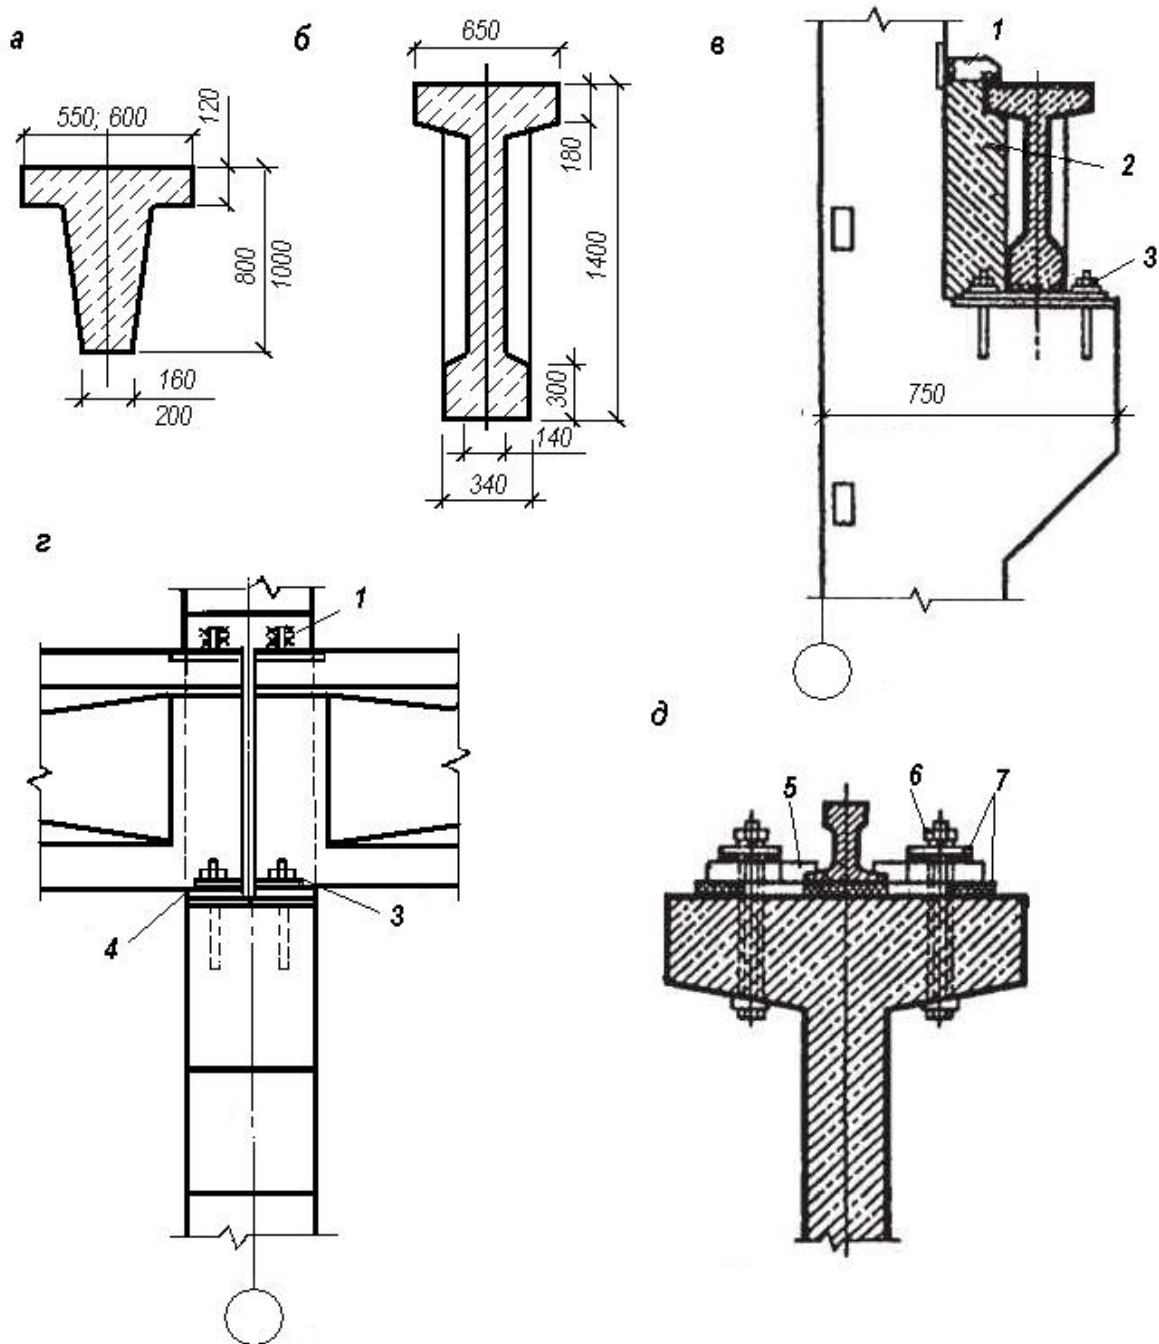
Залізобетонні підкранові балки: а – таврового перерізу для кроку колон 6 м; б – двотаврового перерізу для кроку колон 12 м; в – кріплення залізобетонної підкранової балки до колони; г – кріплення кранової колії до підкранової балки; 1 – сталева кріпильна планка; 2 – бетон, який укладають після монтажу та кріплення балок; 3 – шайби; 4 – опорний лист; 5 – притискна планка; 6 – болт; 7 – пружні прокладки
